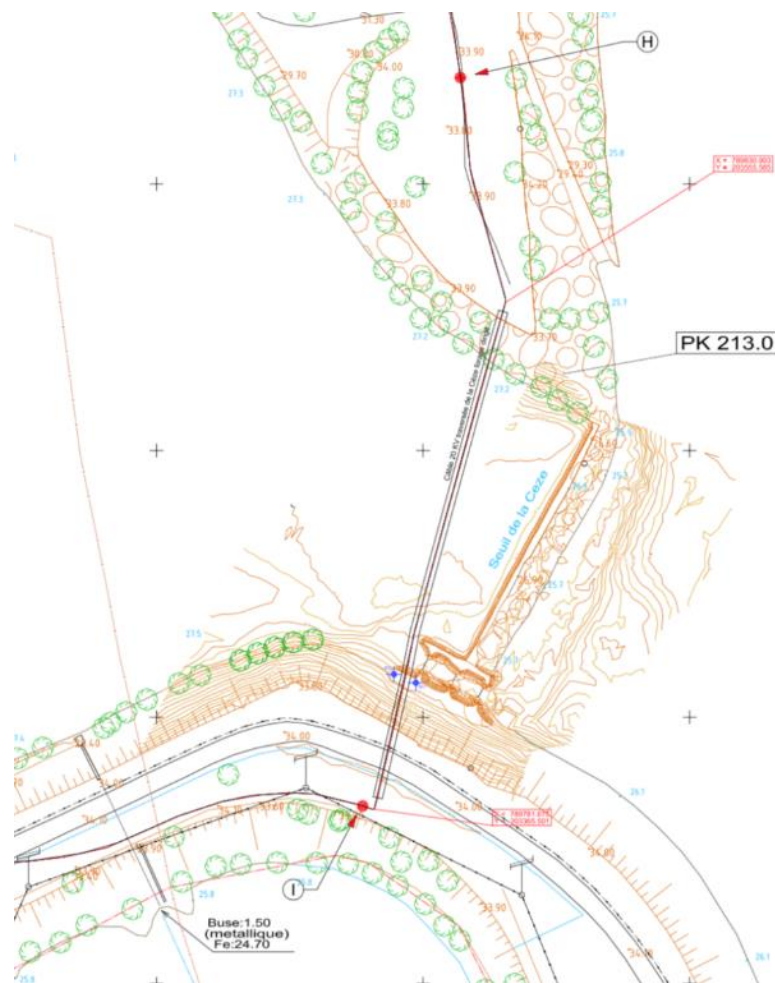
Plan d'ensemble – état avant travaux (AVP CNR)
